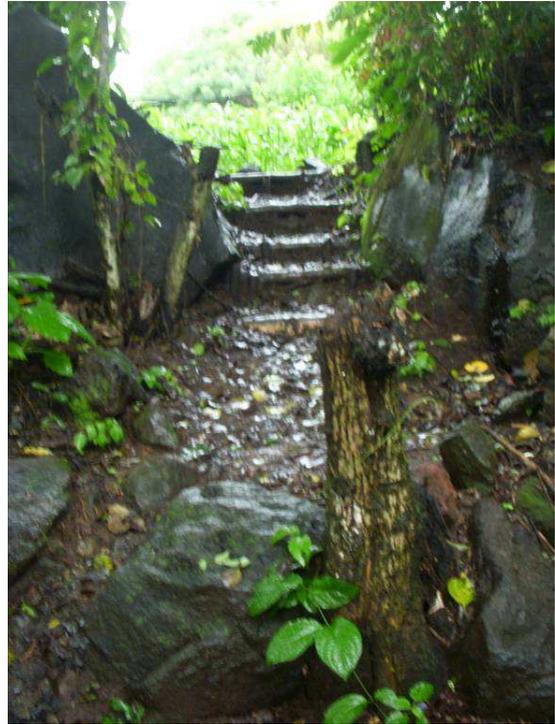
Gradas de senderos en mal estado y obstrucción de piedras en el camino.
